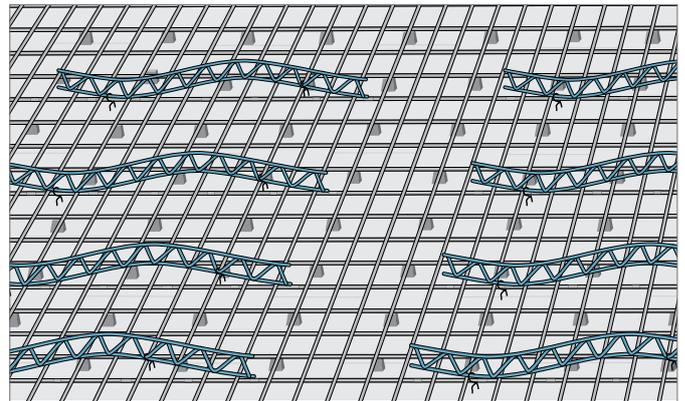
Punto 2 - Montaggio serpentine BKT-S
